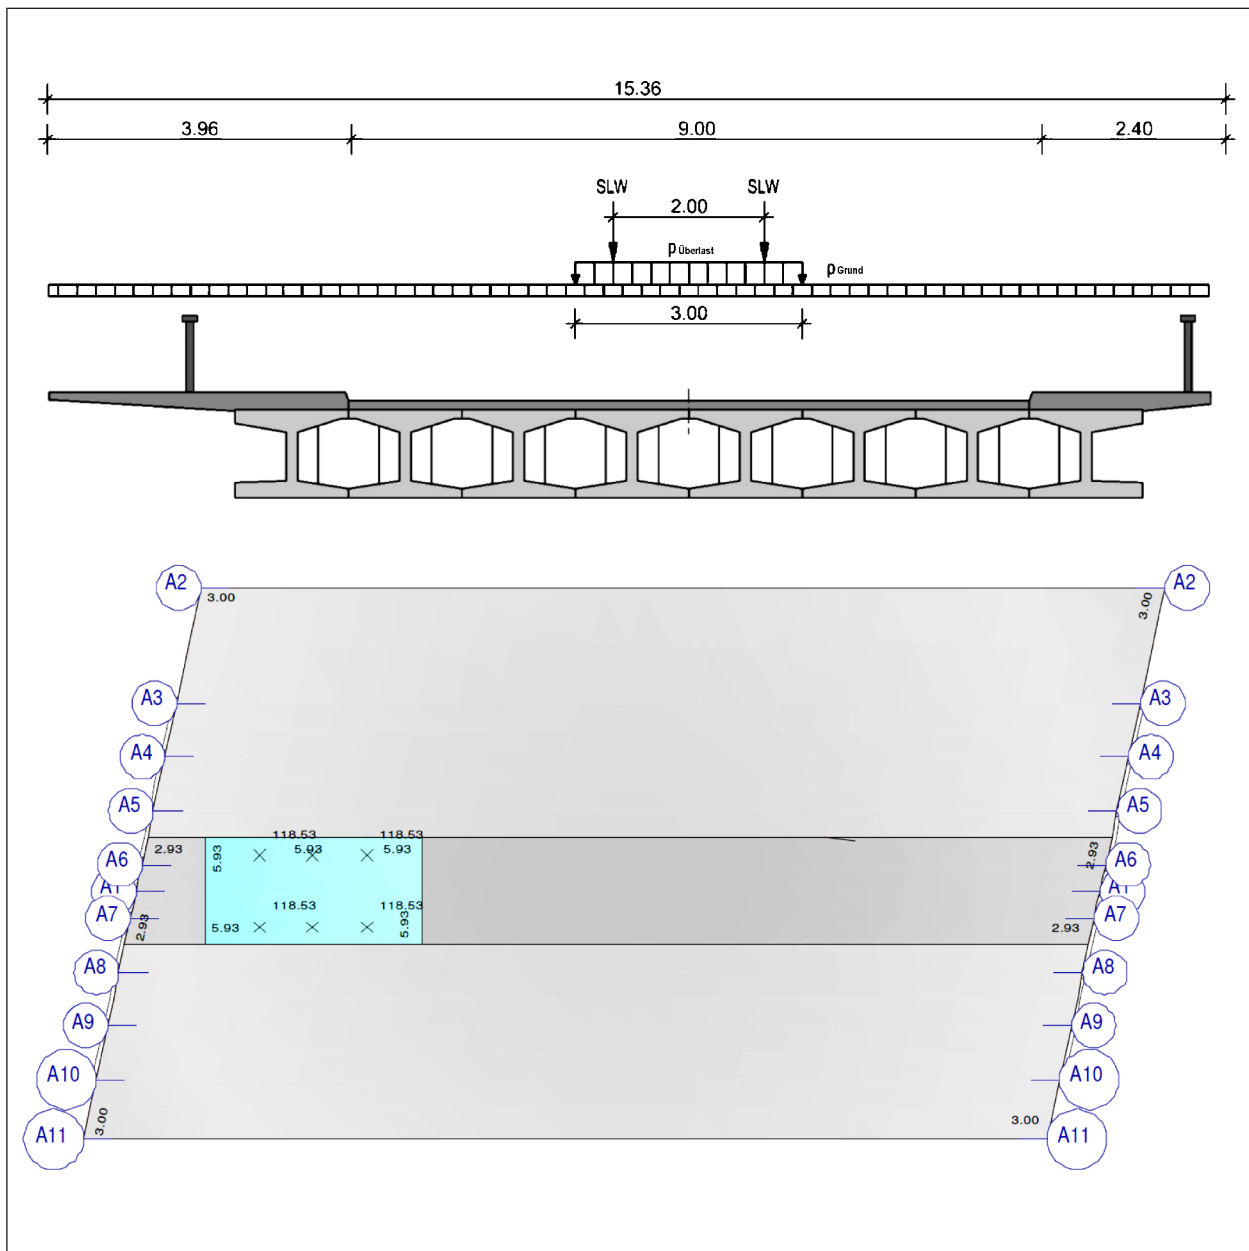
Verkehr BK60 – Laststellung 3: Schnitt und Draufsicht
